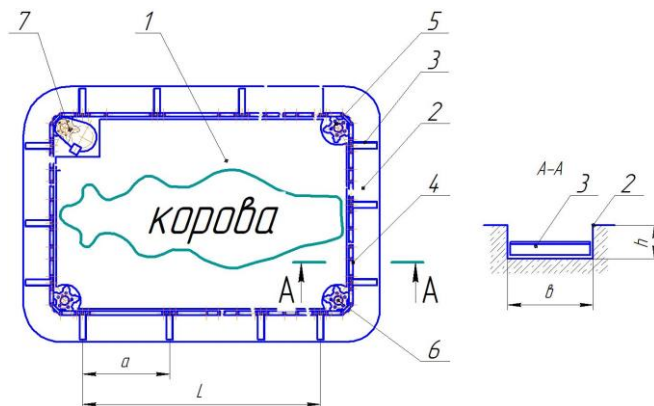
Схема лабораторной установки (фрагмент стойла для КРС привязного содержания): 1 – стойло; 2 – продольный навозный канал; 3 – скребок ТСН; 4 – цепь круглозвенная ТСН; 5 – натяжная звездочка; 6 – поворотная звездочка; 7 – редуктор привода; a – шаг расстановки скребков; L – расстояние хода скребка для определения его скорости; b – ширина навозного канала; h – высота (глубина) навозного канала.
